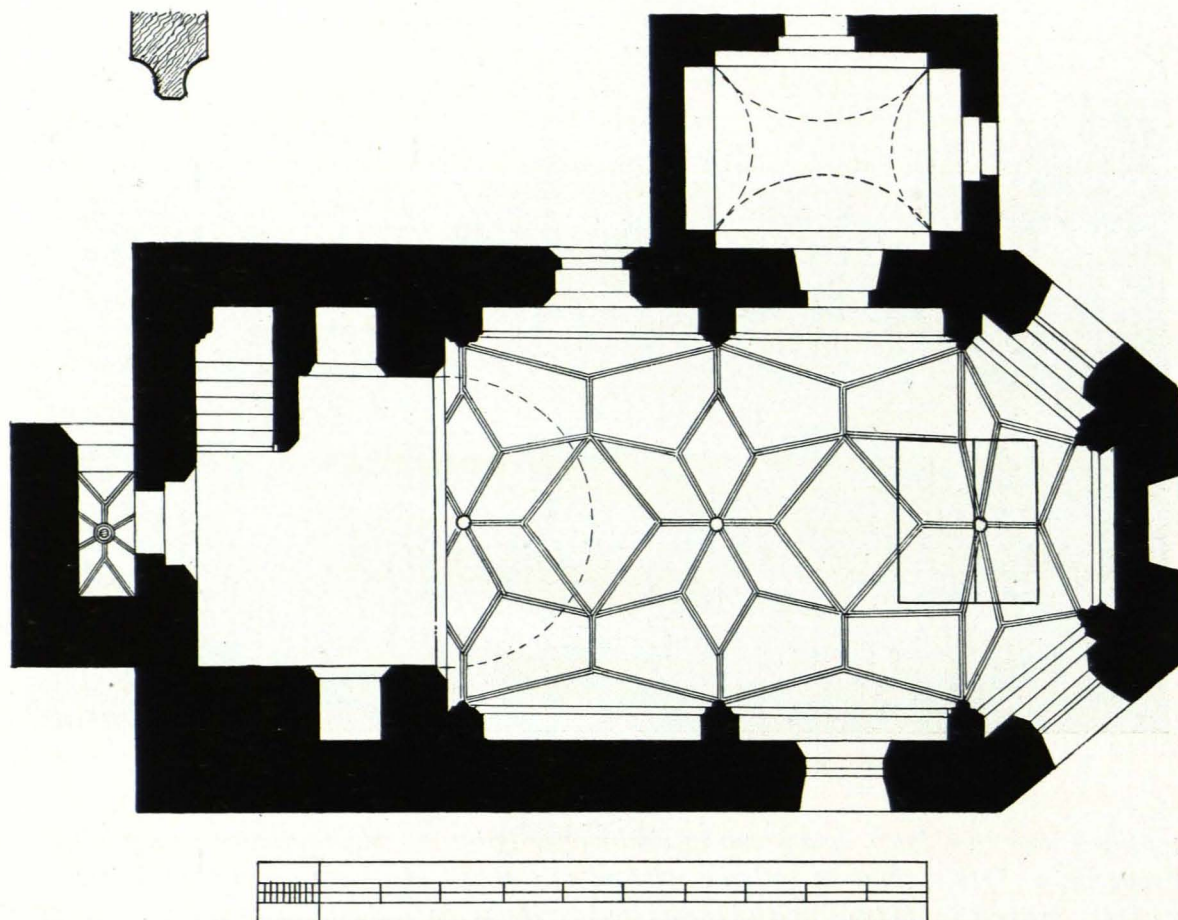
Mühlberg, Fialkirche, Grundriß 1:125 (S. 427)
